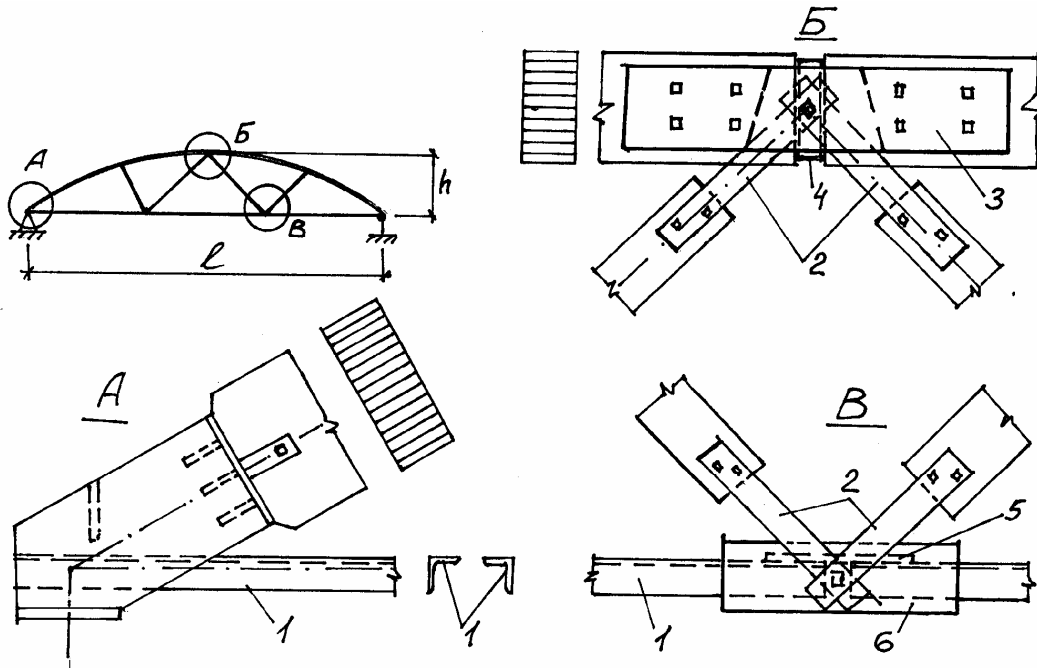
Вузли сегментної ферми з розрізним верхнім поясом:
